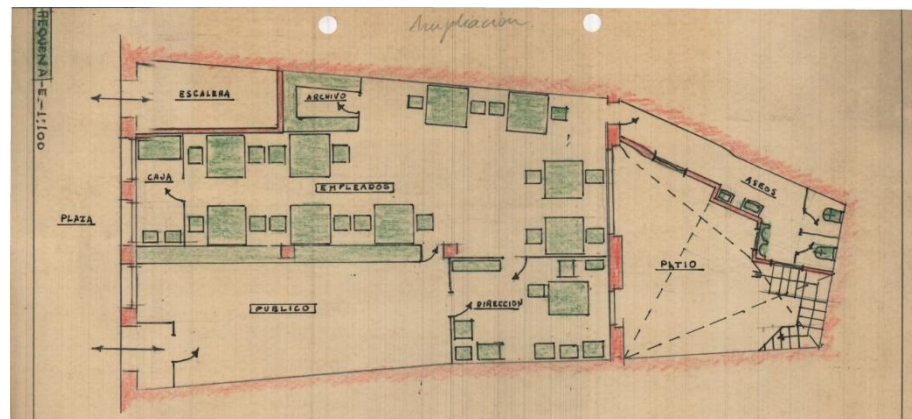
Plano planta baja de la Sucursal del Banco de Valencia
